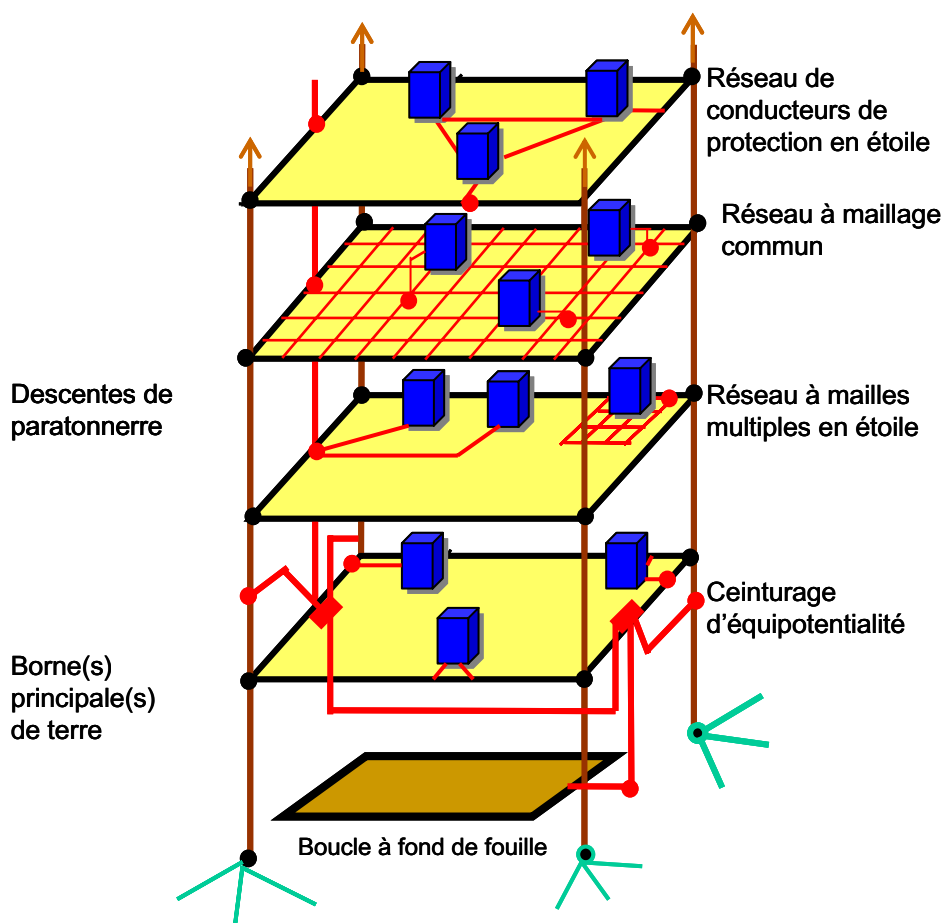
Exemple de ceinturage d'un bâtiment avec paratonnerre
